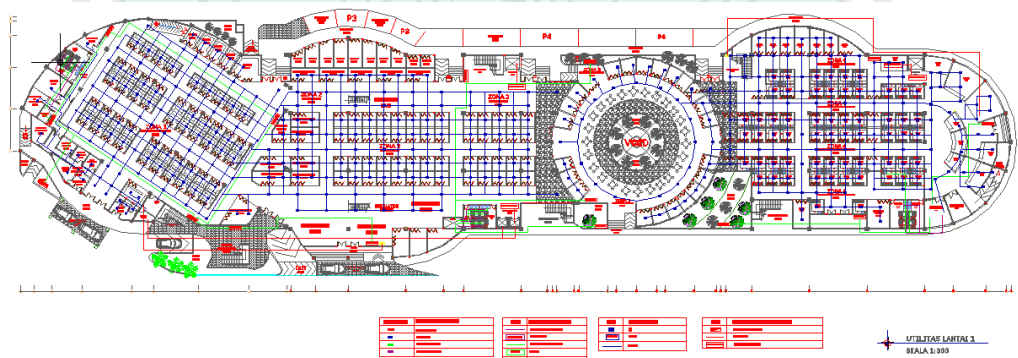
Utilitas Listrik , AC, dan Plumbing pada Layout Plan
